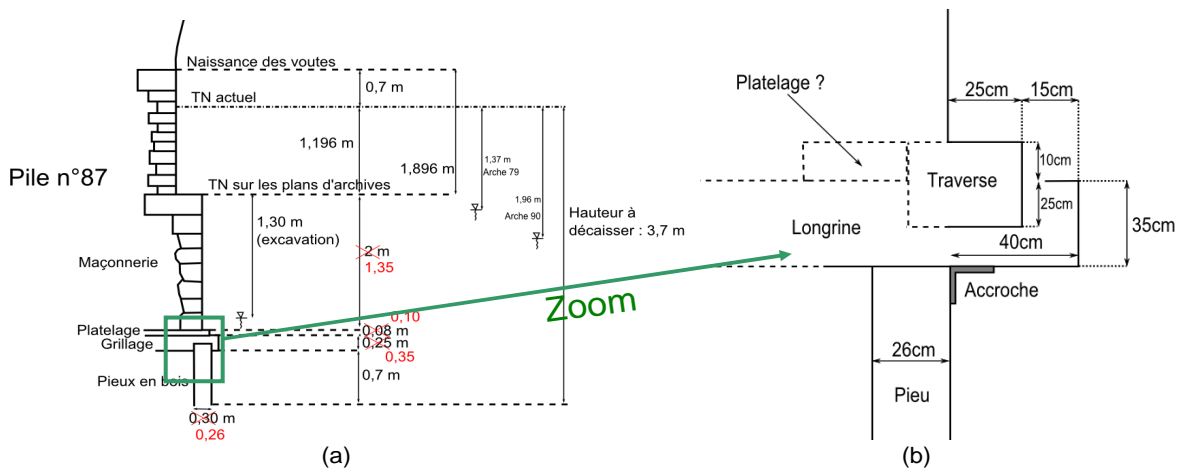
Coupe de terrain au droit de la pile n°87 (a) et zoom sur le platelage, le grillage et les pieux (b)
